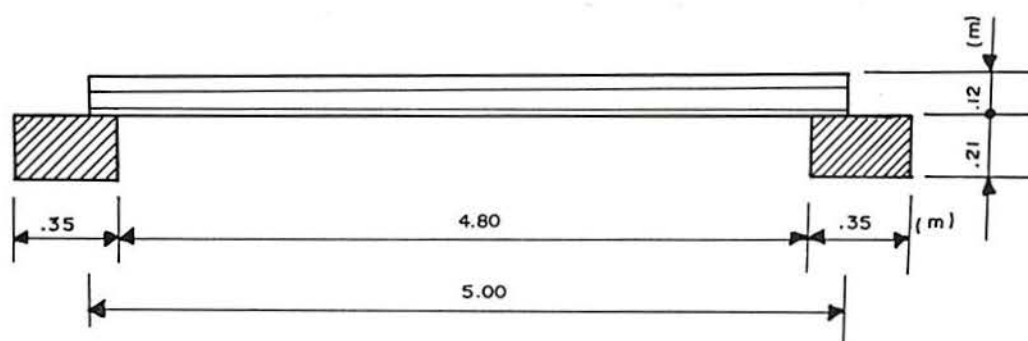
Protótipo apoiado sobre blocos de concreto
